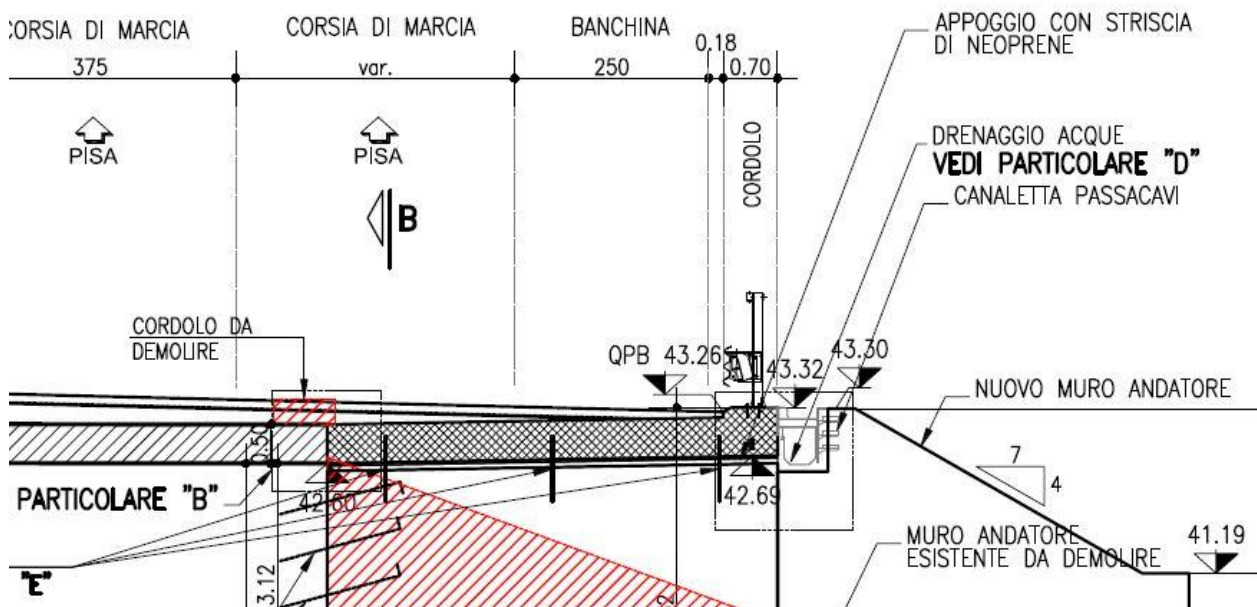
Sezione tipo struttura ampliamento sottovia.
